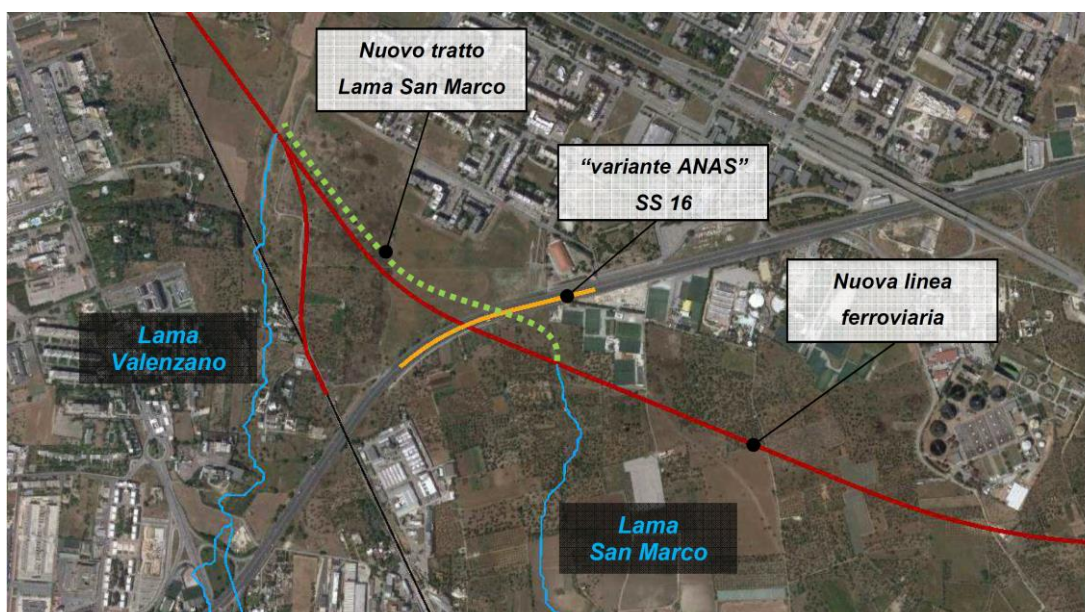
Planimetria dell'attraversamento ferroviario e stradale della Lama Valenzano e della Lama San Marco
